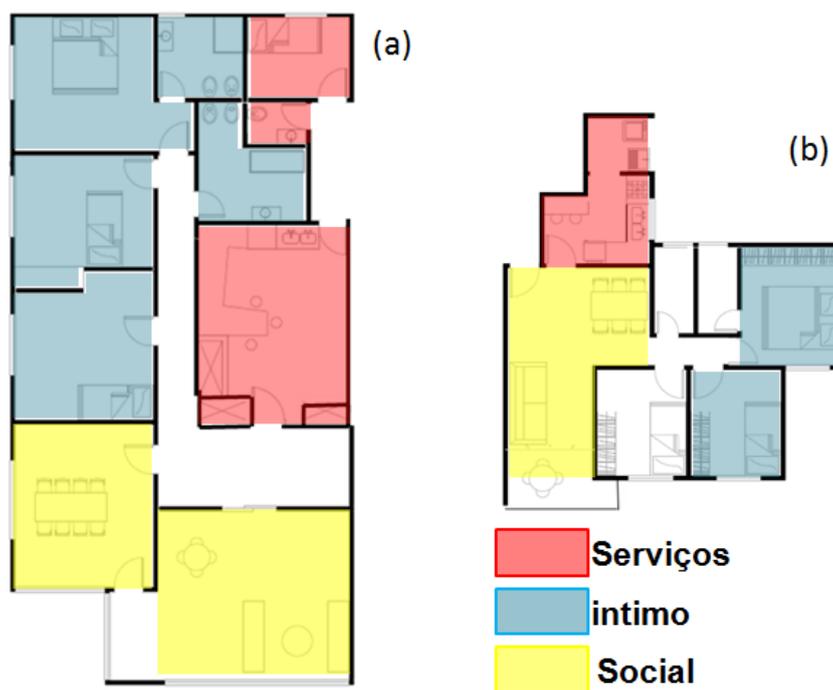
(a) Planta tipo de apartamento de três dormitórios construído em 1955 com área útil de aproximadamente 160m²(b) Planta tipo de apartamento de três dormitórios construído em 2012 com área útil de aproximadamente 75 m².
